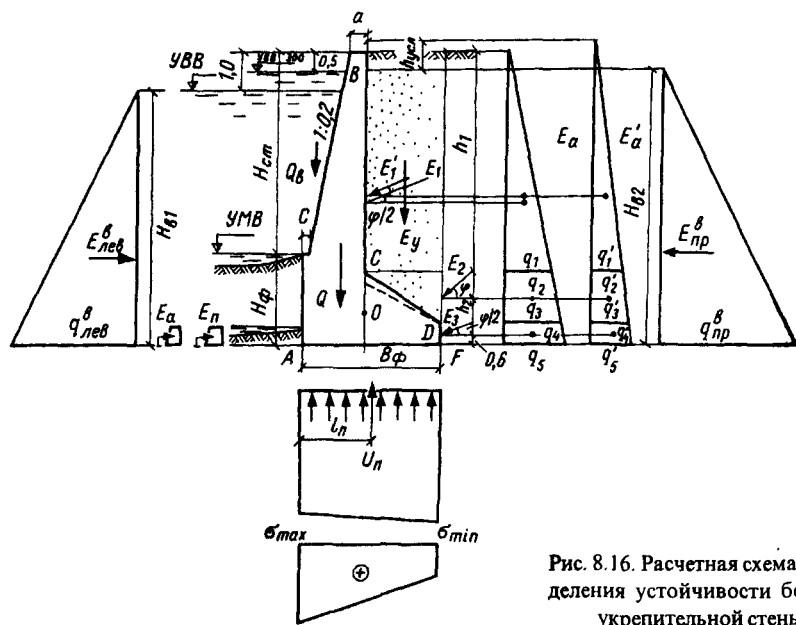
Расчетная схема определения устойчивости берегоукрепительной стены
